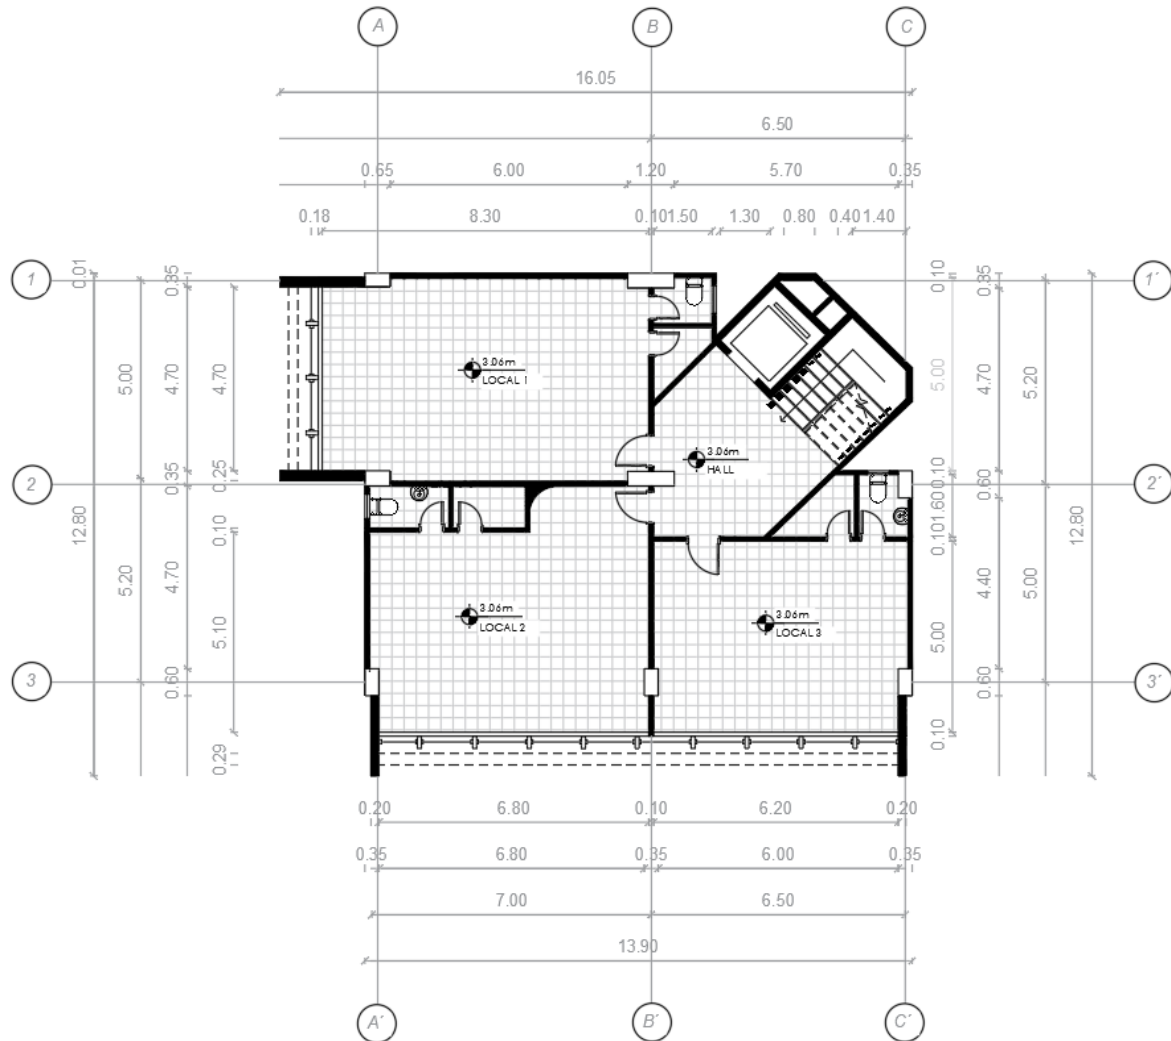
ESTOA edificio "El Ejecutivo". Planos arquitectónicos, Plantas tipo.
